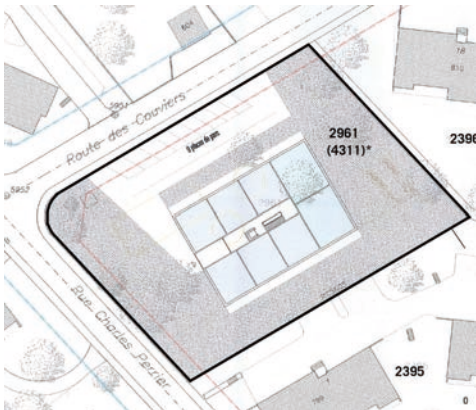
Variante d'implantation B (Source : ©GD architectes)
